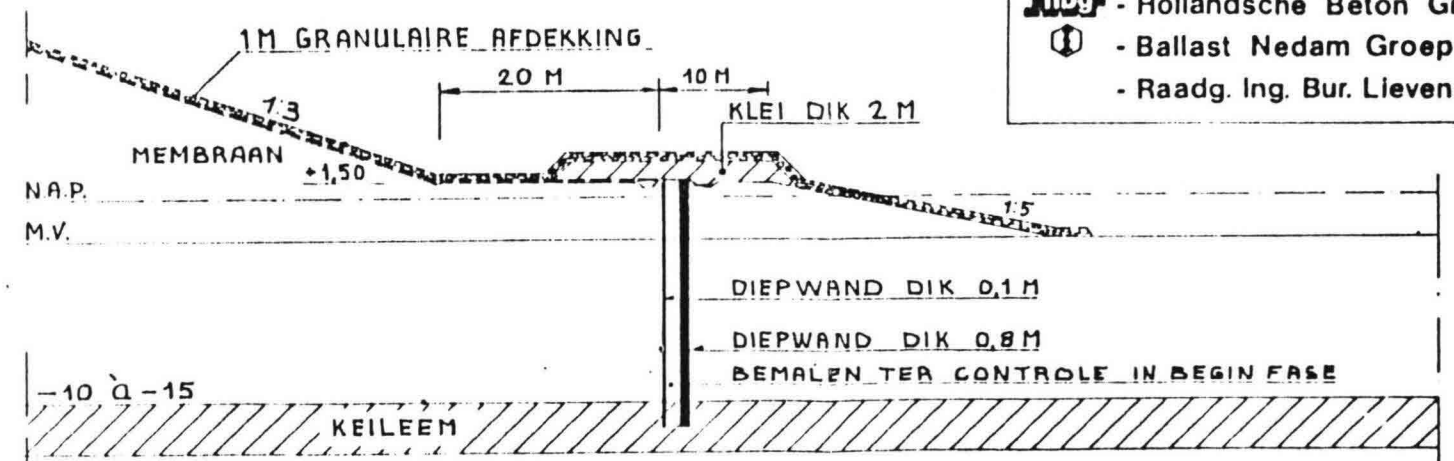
BEMALEN, ALLE BEMALEN VARIANTEN
